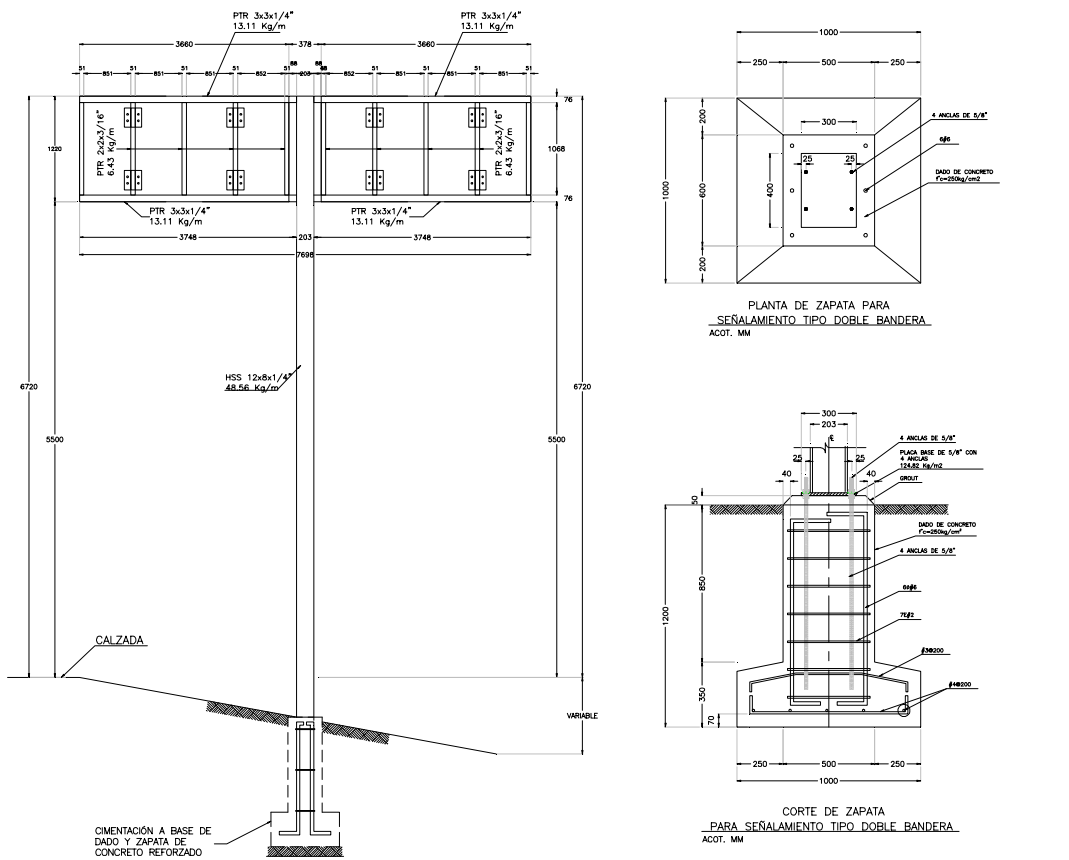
Detalles estructura de soporte de las Señales Elevadas SID-13 y SID-14
